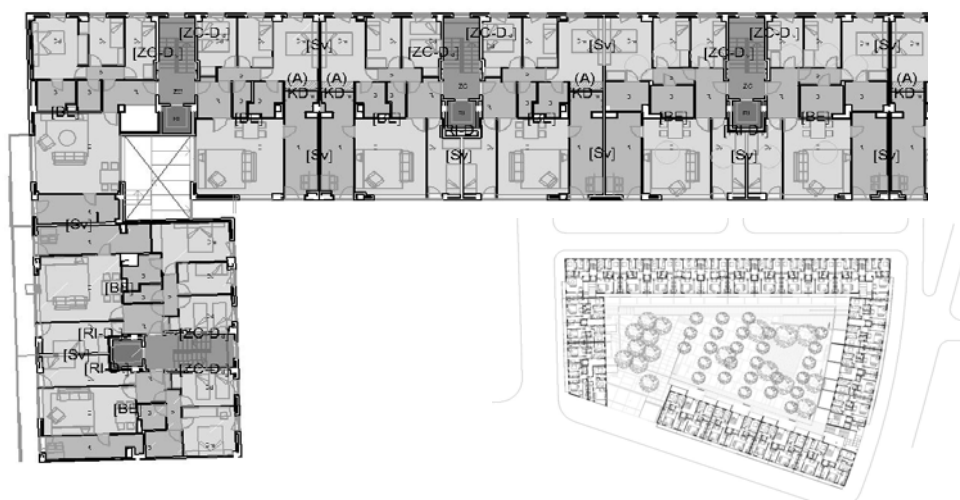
Planta tipo de las viviendas del Prat de Llobregat
